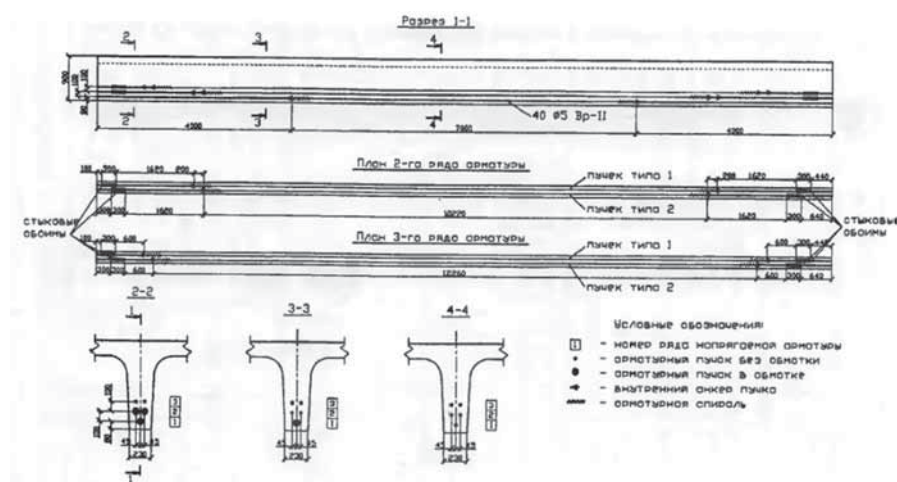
Схема армирования напрягаемой арматурой балок длиной 15 м [12]
